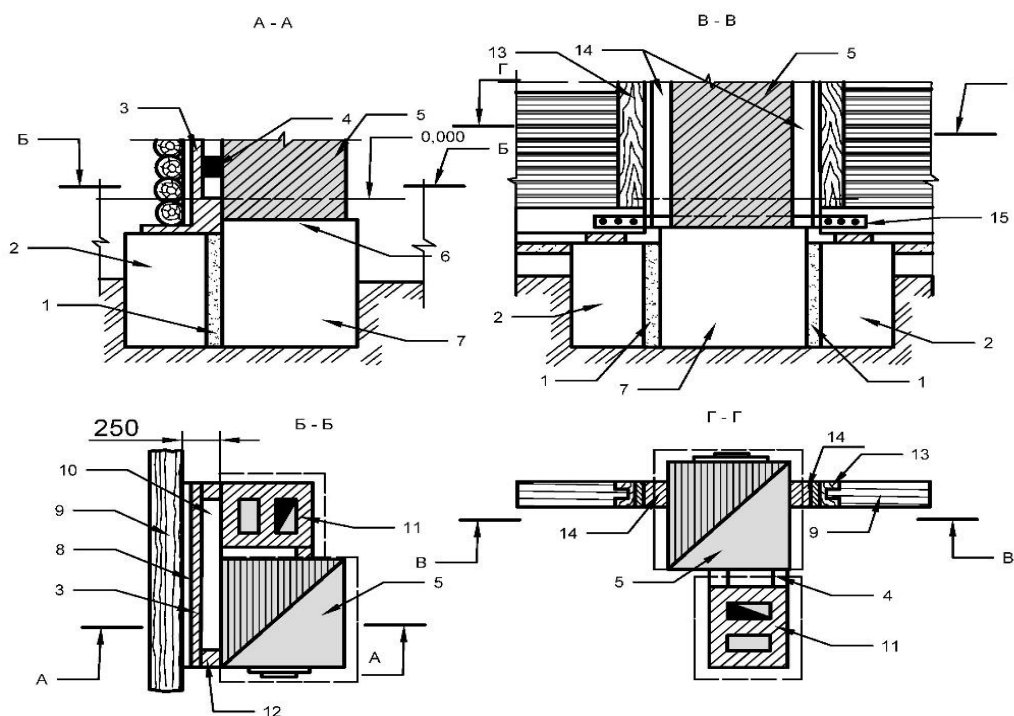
Конструкция фундаментов печей, устанавливаемых в деревянных зданиях:
